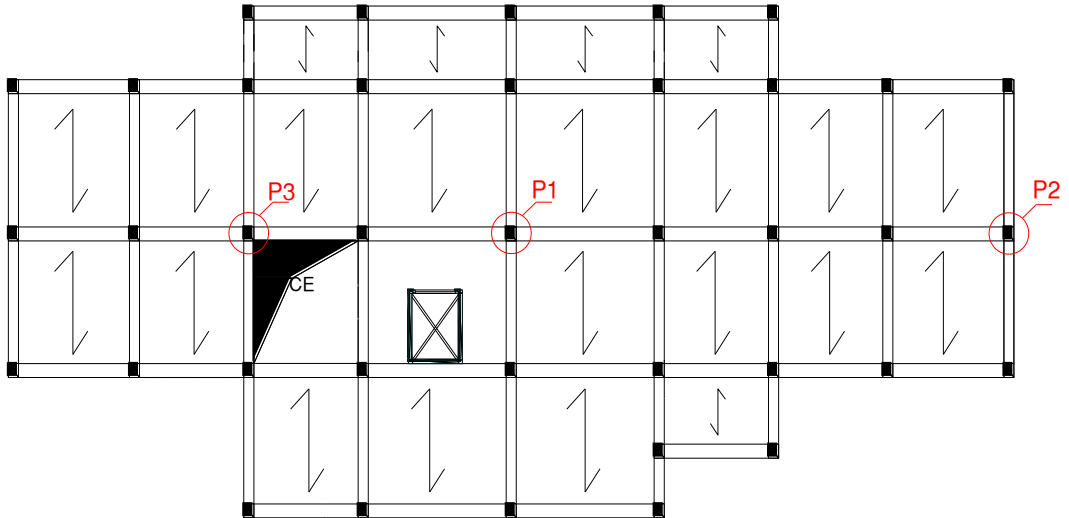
Plan de repérage des poteaux dans la descente de charge.
